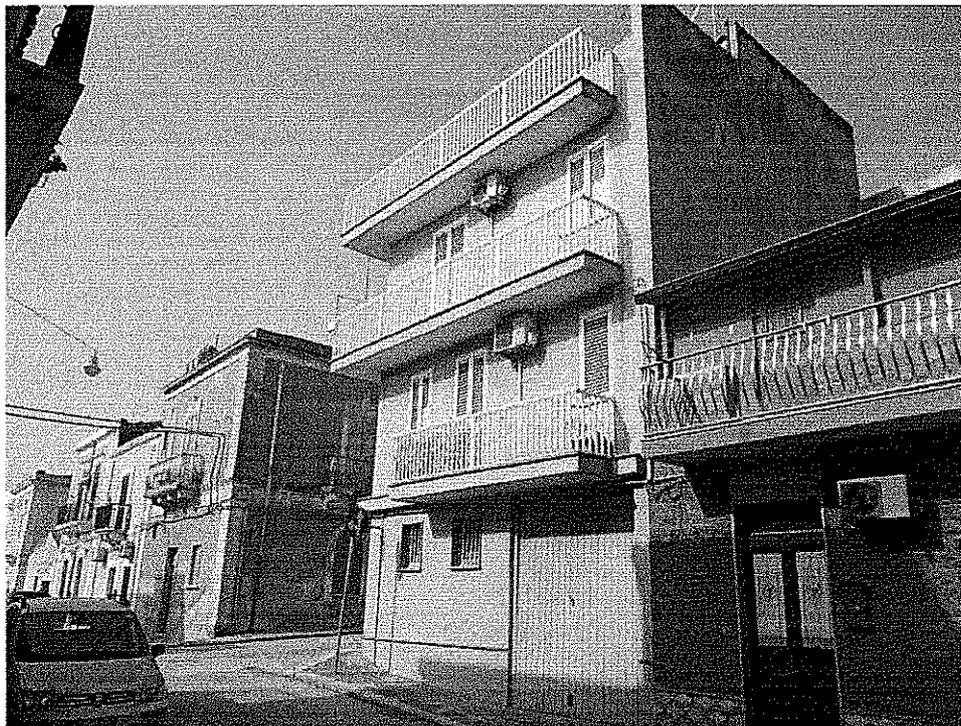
Fabbricato “1A” - Prospetto su via Mulino
